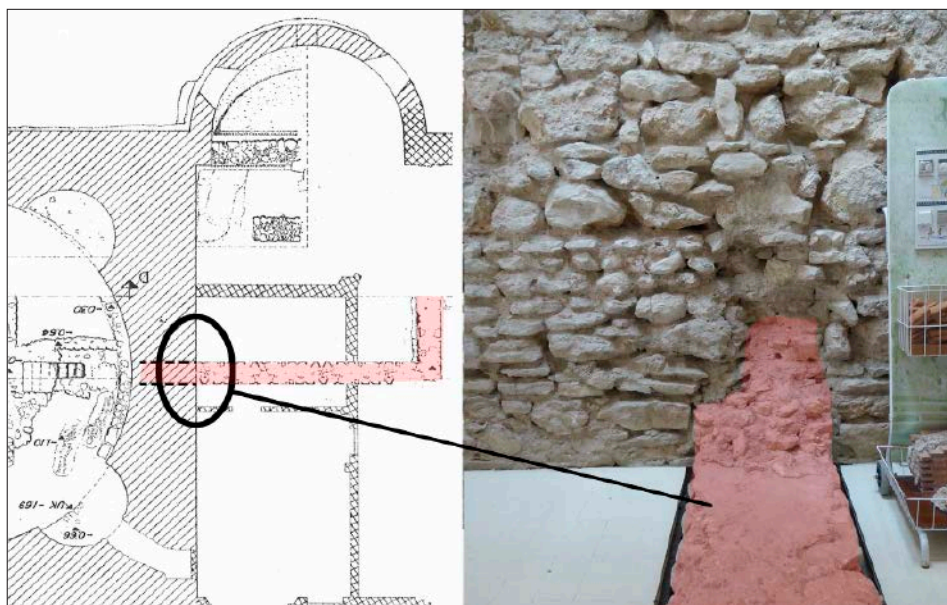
Planta y fotografía donde se observa como el ámbito 7 se superpone al muro que separa los ámbitos 5 y 6, que es de una fase constructiva anterior.
